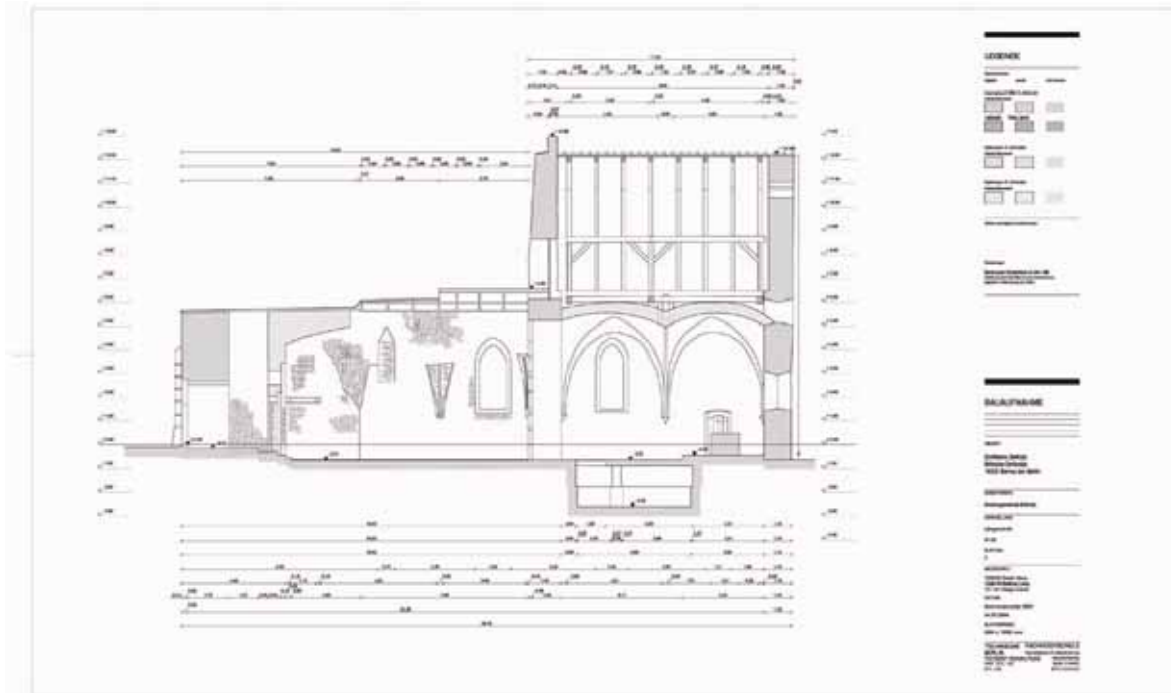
Bauaufnahmeplan: Längsschnitt der Kirche Birkholz⁵⁵
